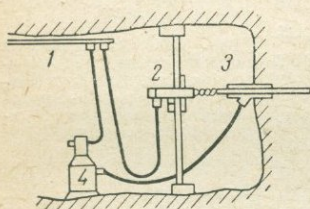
Установка для пневматического сбора буровой пыли из шпуров
